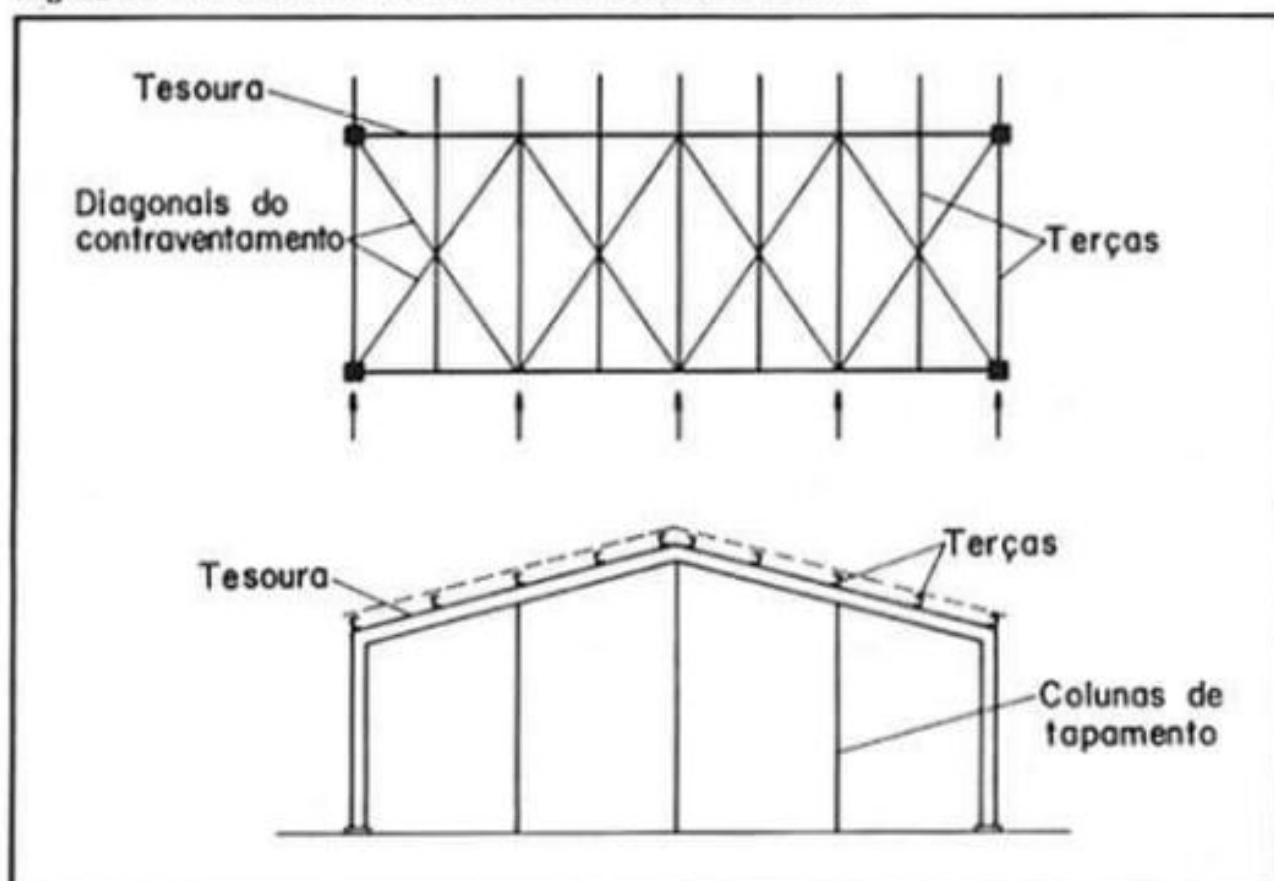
TRELIÇA DE CONTRAVENTAMENTO
